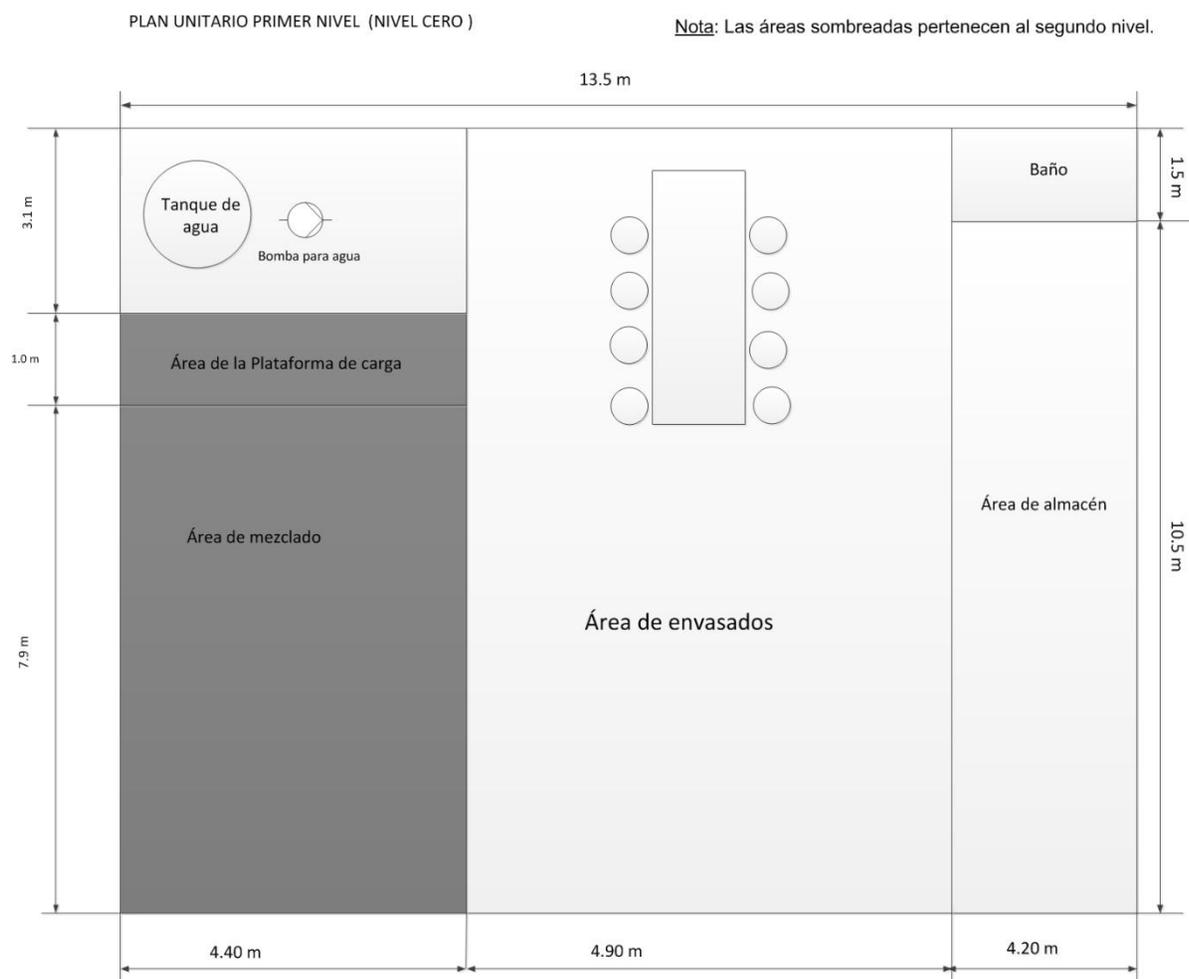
Plan unitario 1er nivel. Fuente: Elaboración propia
